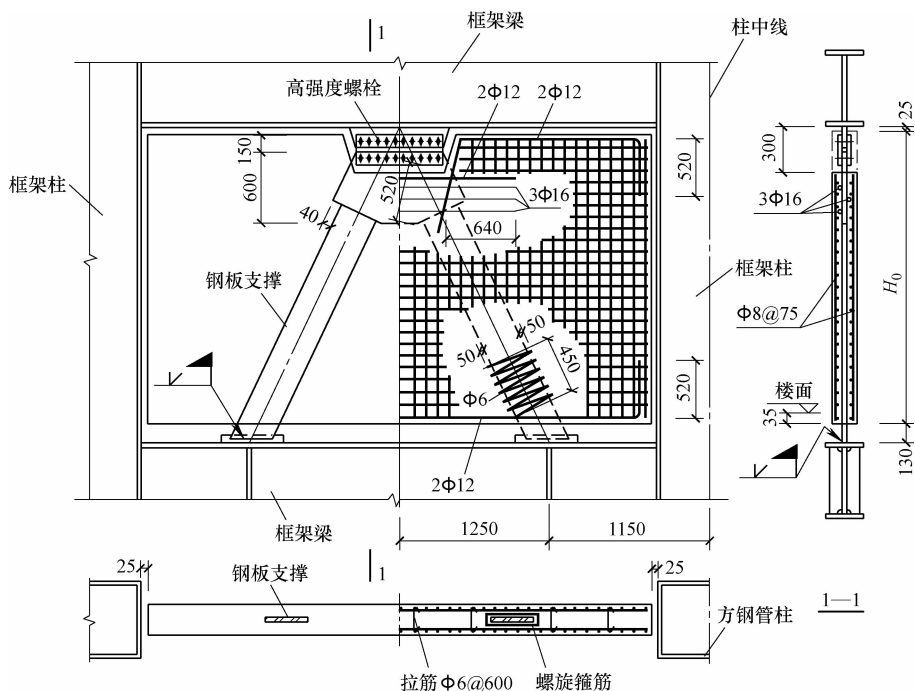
内埋人字形钢板支撑的钢筋混凝土墙板
